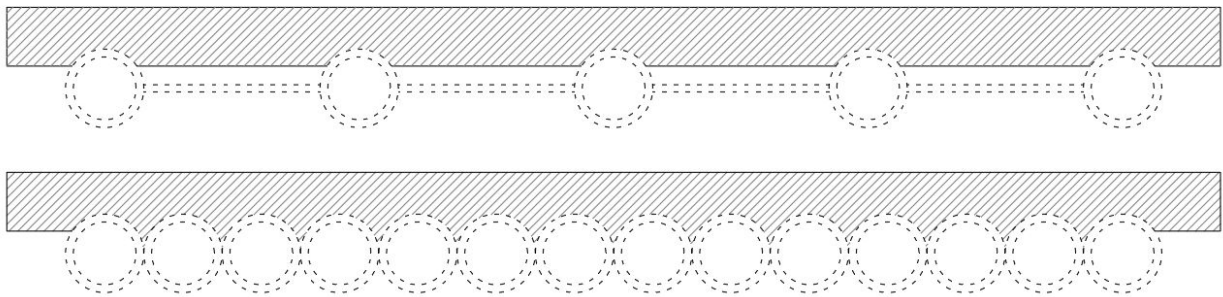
1. Platbenzi de fixare din oțel
